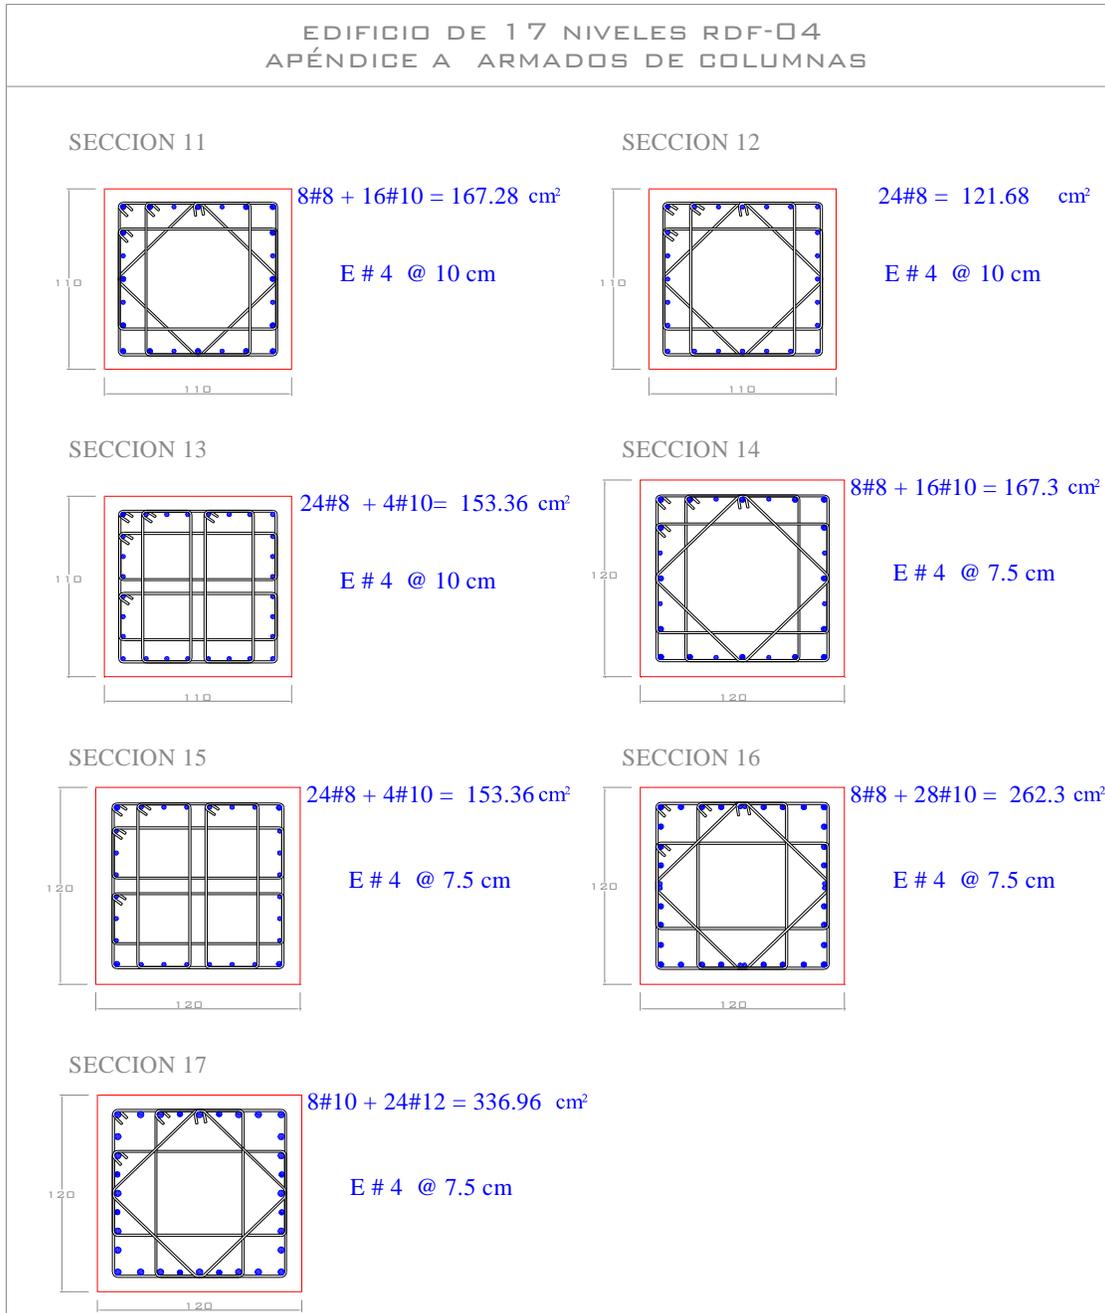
Armados de acero longitudinal y transversal propuestos en columnas, edificio 17 niveles, Apéndice A (caso B) de las NTC-Sismo, RDF-04
